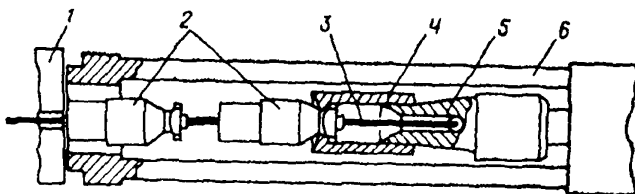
Схема переоборудования гидродомкрата ДГС-63-315 для натяжения стержневой арматуры, закрепляемой инвентарными зажимами
